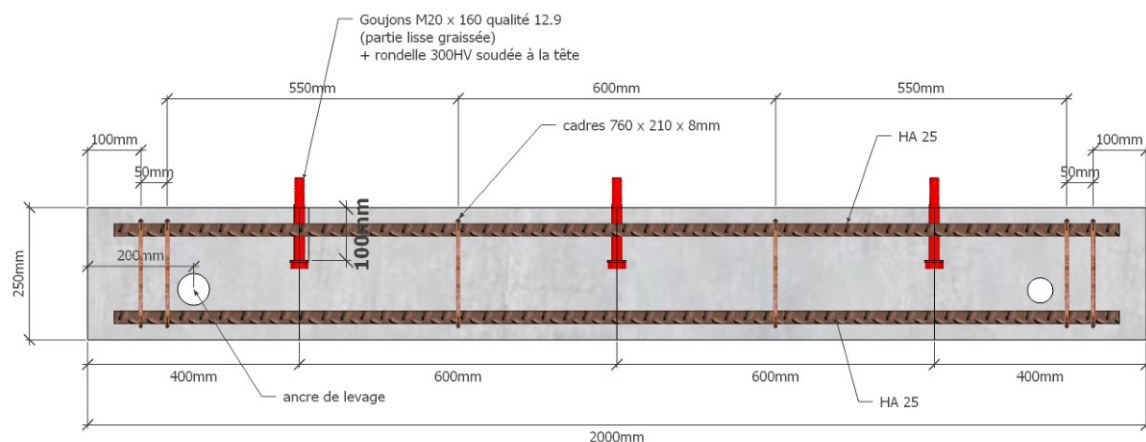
Dimension de la dalle étudiée : Section.
